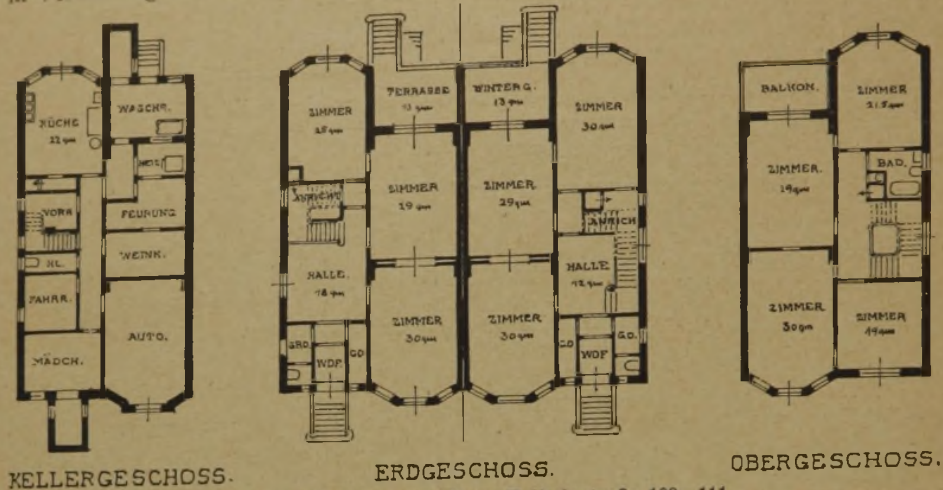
Grundrisse zum Haus Heilwigstraße 109-111.
